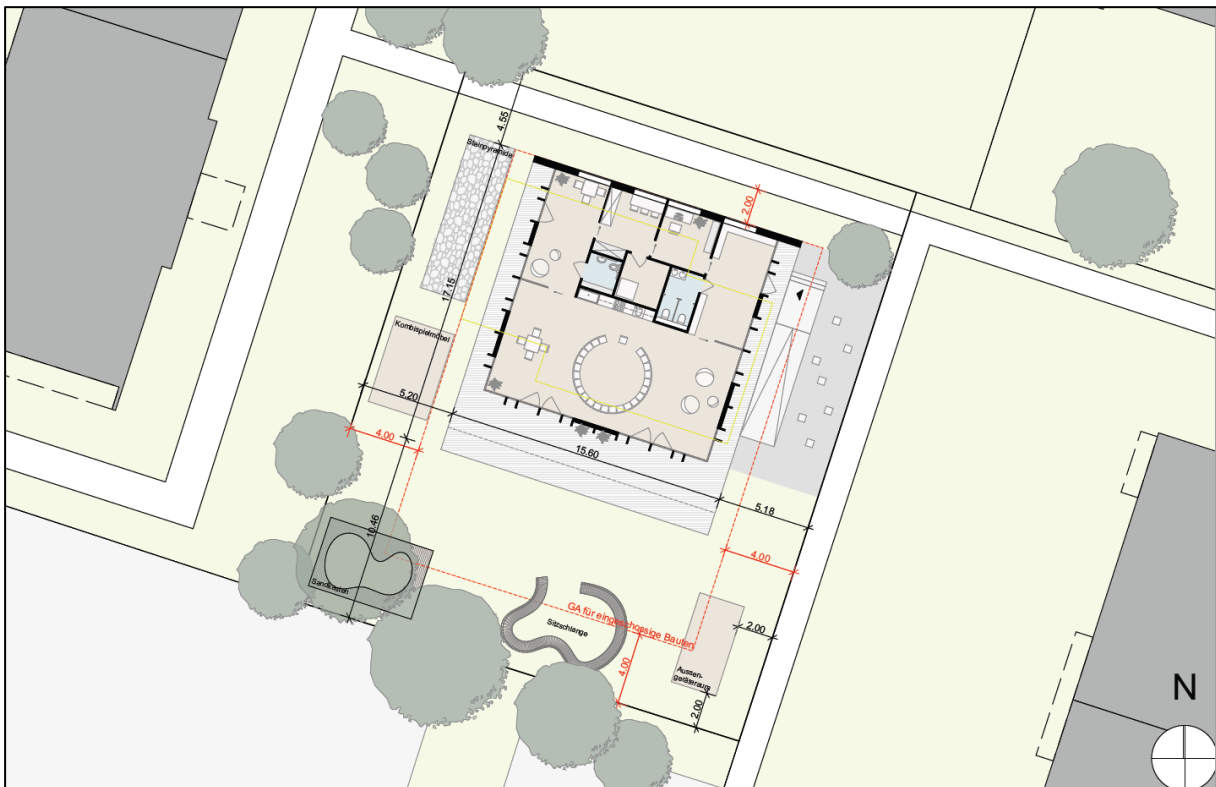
Situationsplan Neubau Kindergarten Nobsstrasse 19 / Unterdorf
